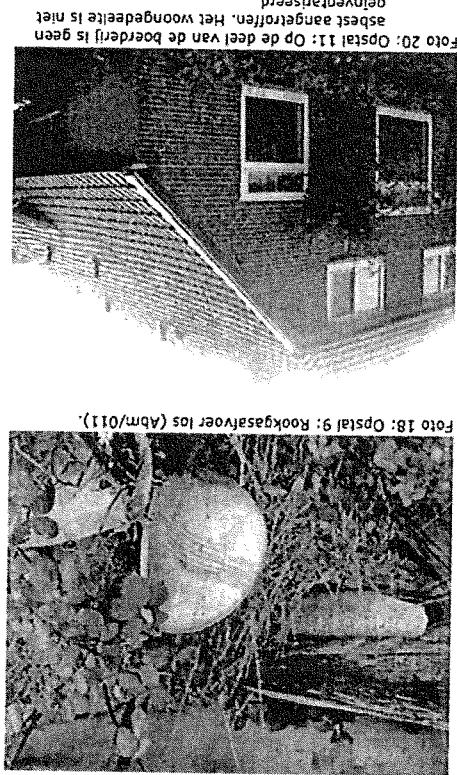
Opslag 9: Rookgasafvoer los (ADM/011).
